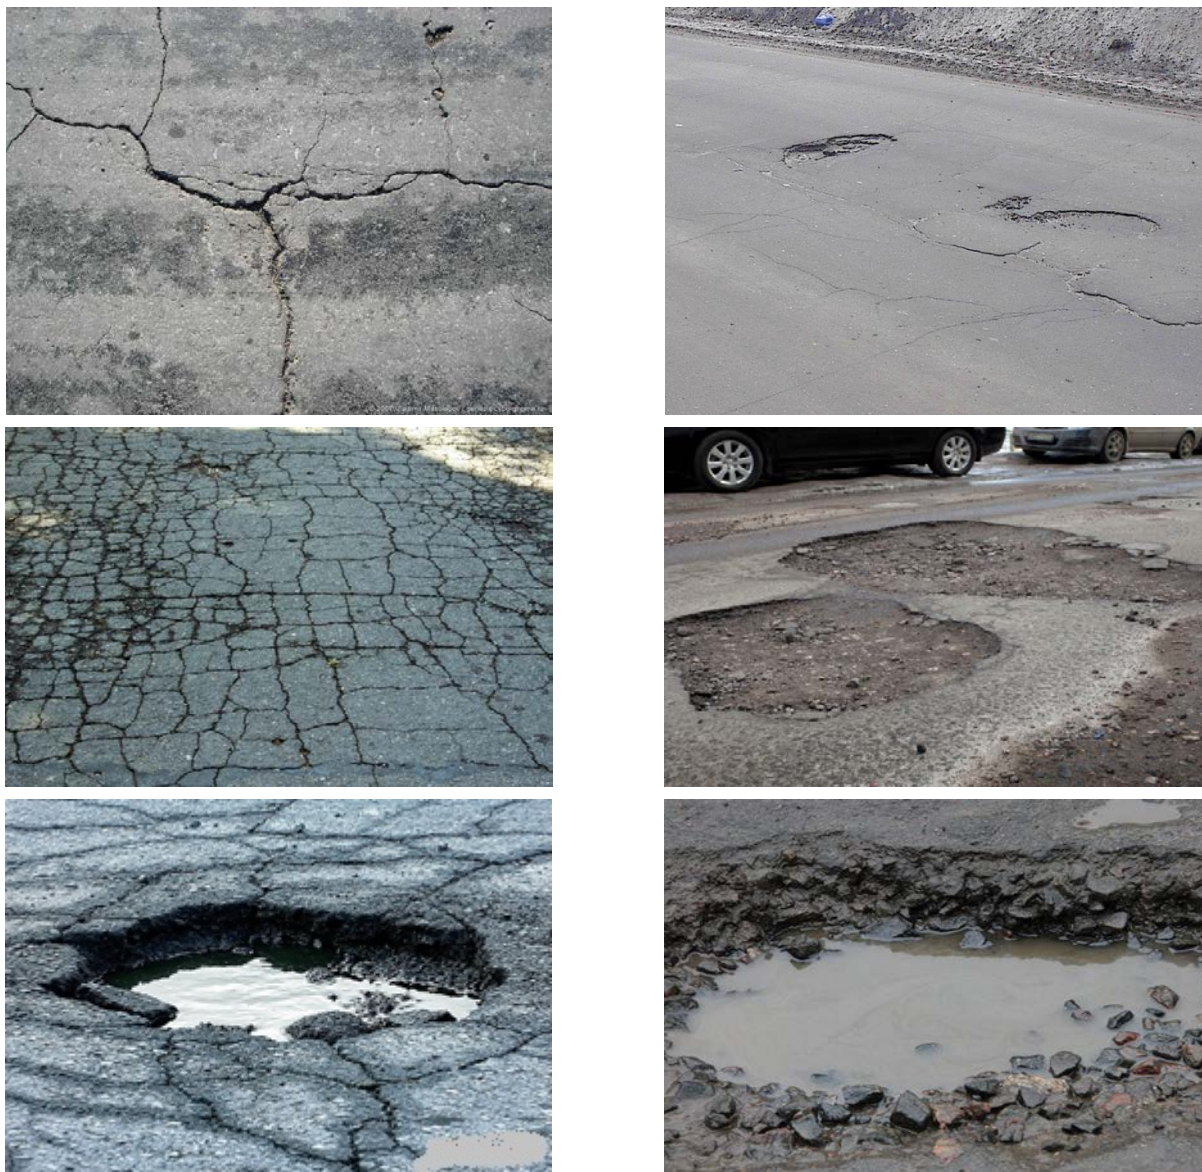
Виды разрушений асфальтобетонного покрытия
